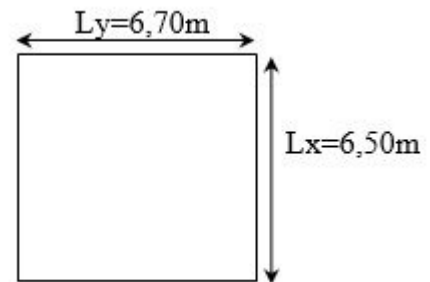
Dimensions D'un anneau De Dalle Le Plus Défavorable.
